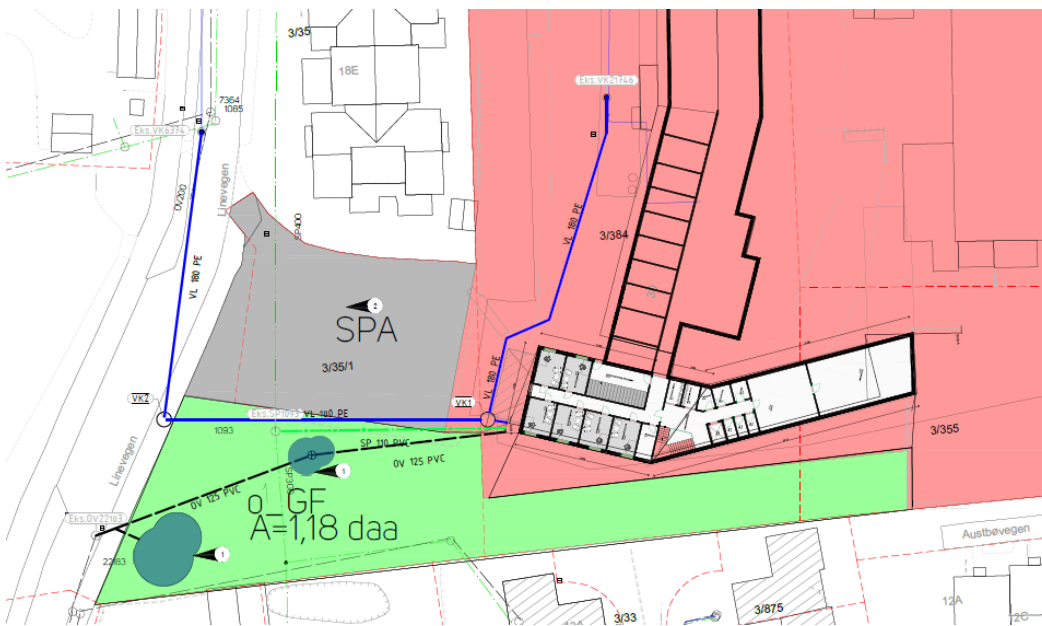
VA- Rammeplan med prinsippkisse spillvannsledning (grønnstiplet linje).
